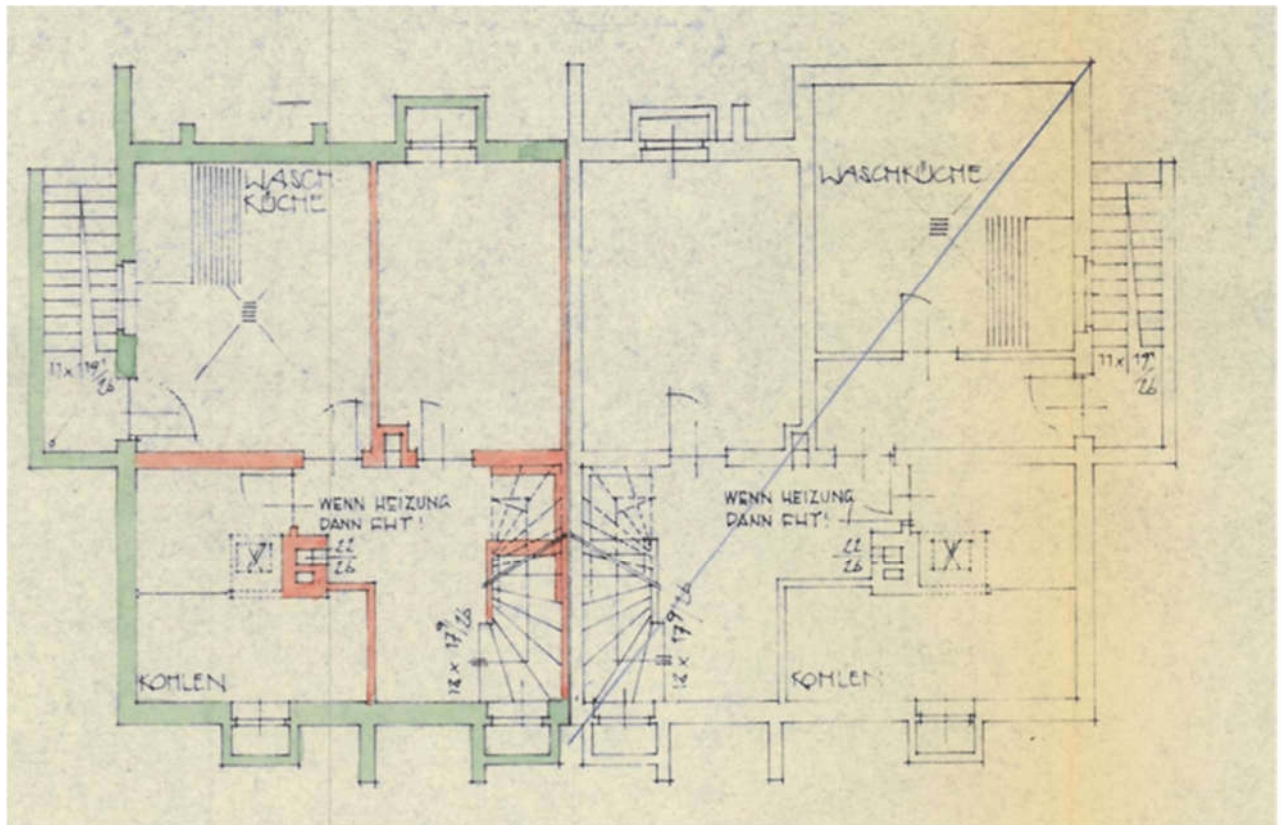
Abbildung 11 Grundriss Kellergeschoss
